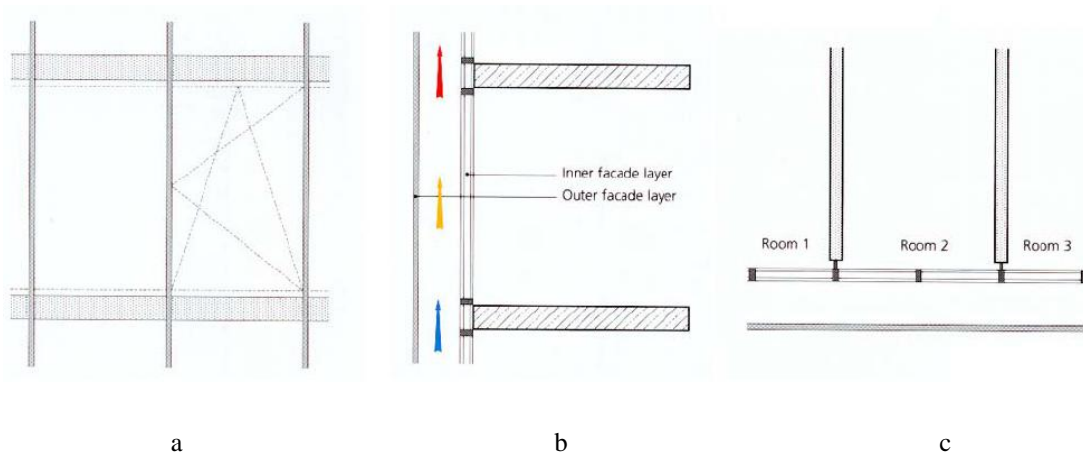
Multi-piso: Vista frontal - a); Secção transversal – b); Vista em planta – c) (Oesterle et al, 2001).
